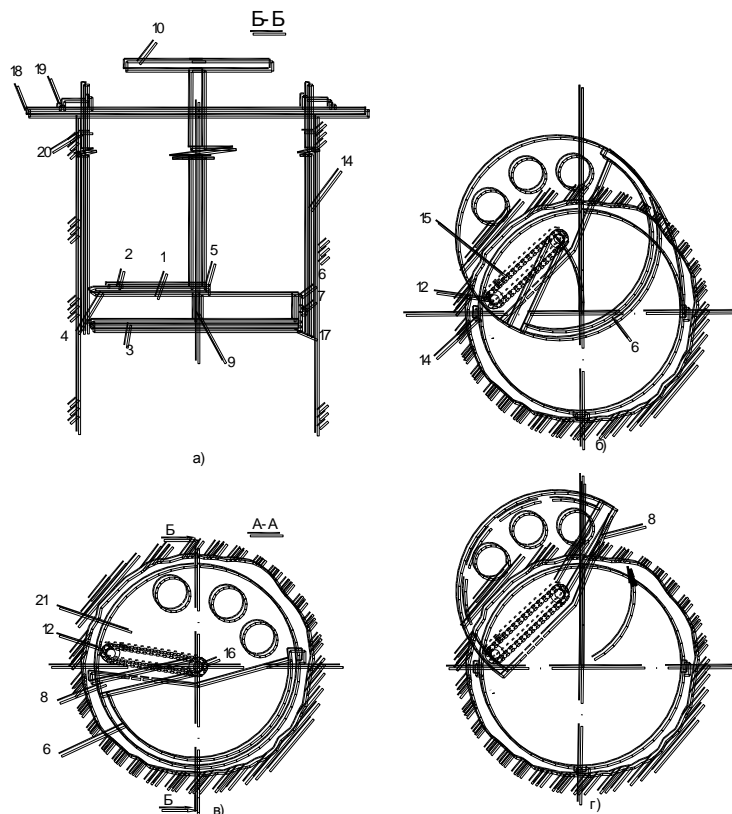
Грунтозаборное устройство со стенок скважины (а) продольный разрез, б) план, в) рабочее положение 1, г) рабочее положение 2)
